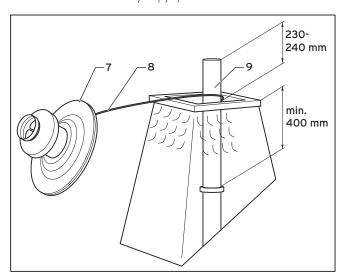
Монтаж насадки для шахты, арт. № 303 261
